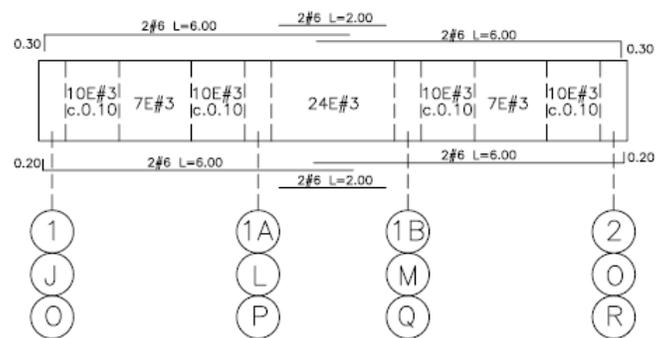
Detalle refuerzo zapata Z2, viga de cimentación Z4, Z5 y Fundición zapata
